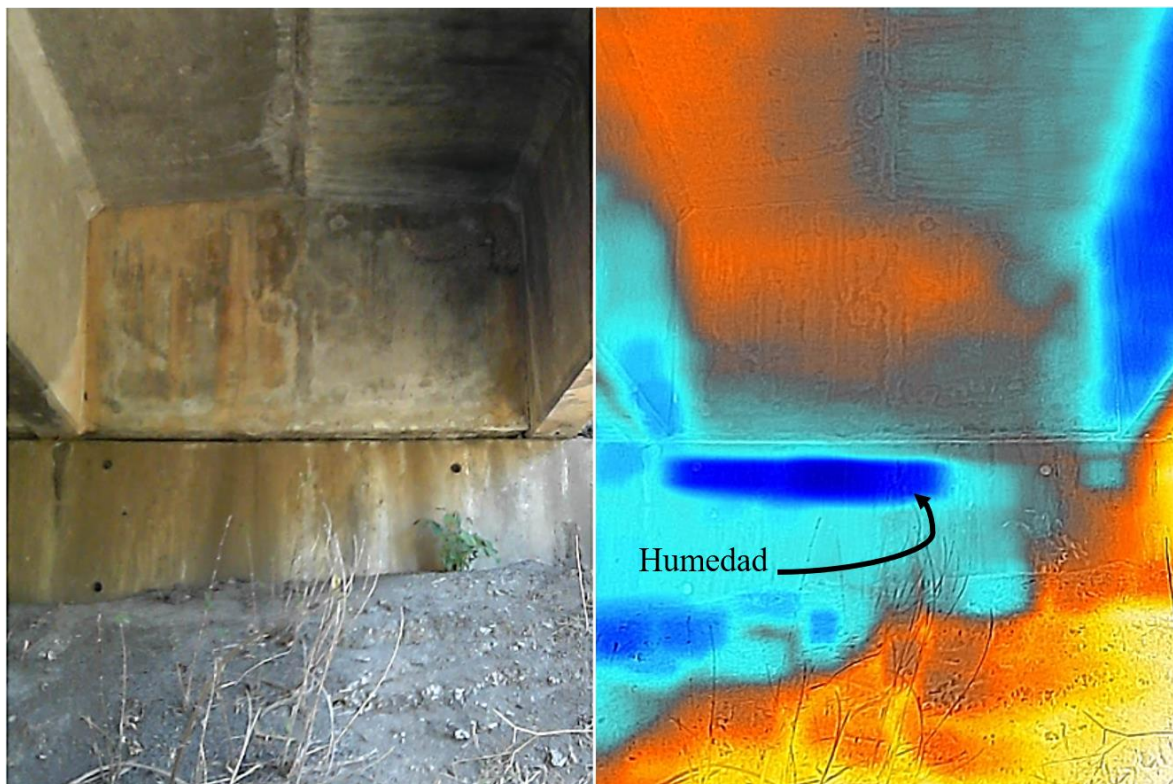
34 Detalle de estructuras con humedad producto de filtraciones en juntas de expansión de la sección No. 9
